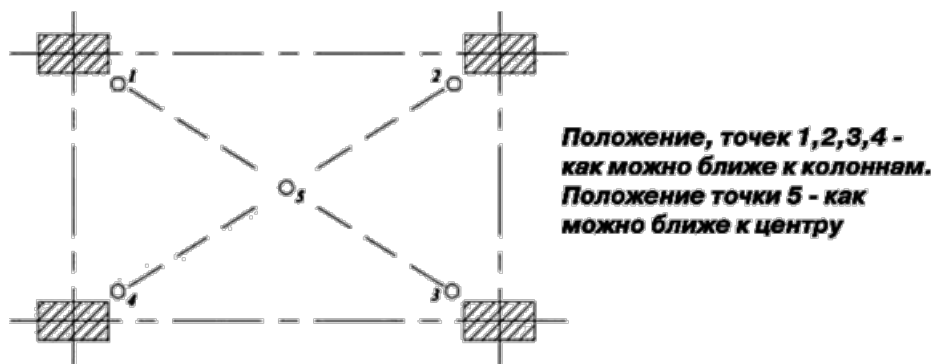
Перед бетонированием во время окончательной нивелировки опалубки плит среднюю зону между колоннами следует поднимать на 10-20 мм
